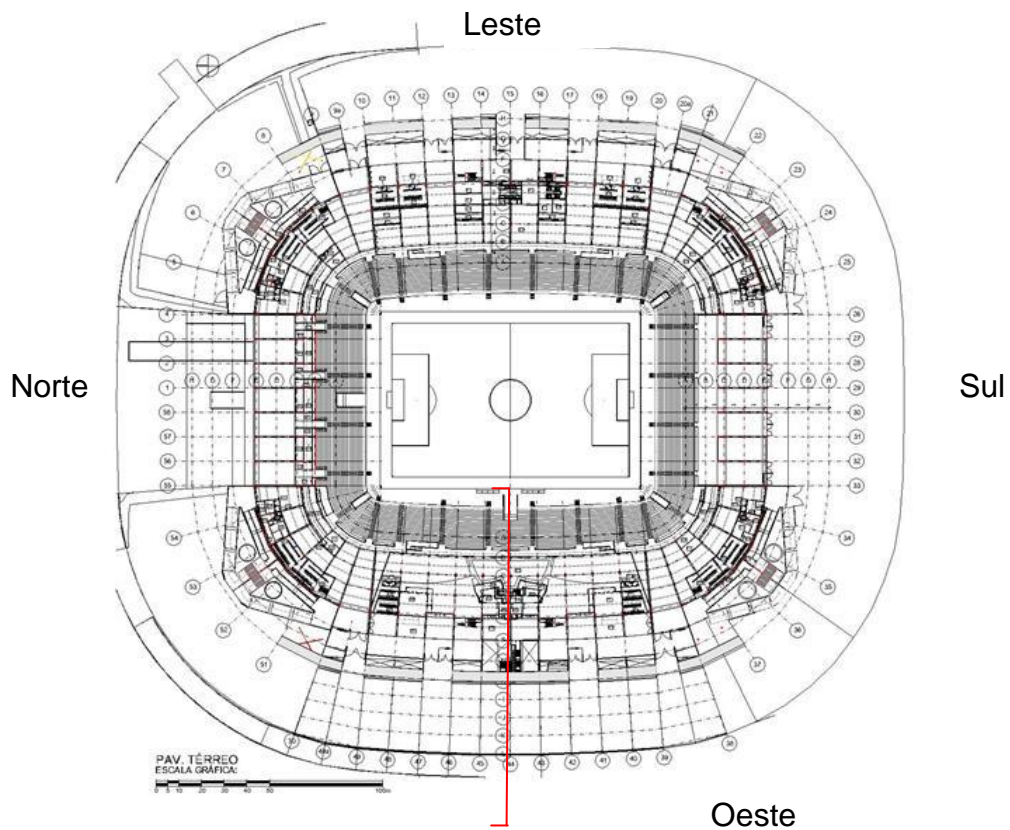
Planta pavimento Corte 01 do Arena PE - Julho 2012.
